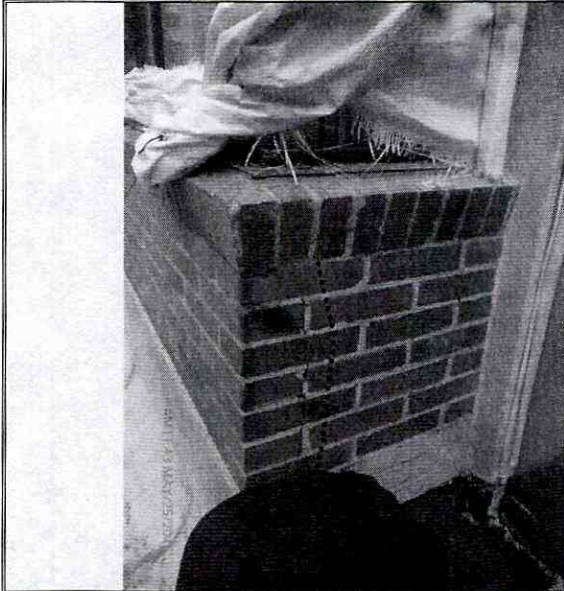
Presencia de grietas y fisuras en los muros de cerramiento de la zona de estacionamiento del Conjunto Residencial La Esperanza I y II P.H. de la Calle 163B No. 45 - 32, en el Sector Catastral Britalia de la Localidad Suba.
